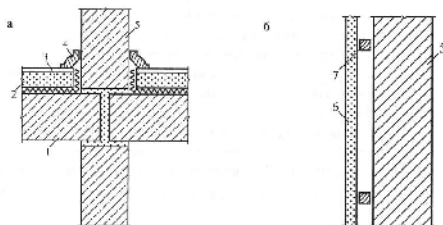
Звукоизоляционные мероприятия при слоистых ограждающих конструкциях: а — в междуэтажном перекрытии — звукоизоляция стыка между основанием слоистого пола и стеной, б — при креплении гибкой звукоизоляционной облицовки к массивной несущей стене; 1 — плита перекрытия, 2 — плита основания пола, 3 — слой звукоизоляции, 4 — плитус, 5 — стена, 6 — гибкая облицовка (плита Тизик — Кнауф или др.), 7 — деревянный каркас облицовки
